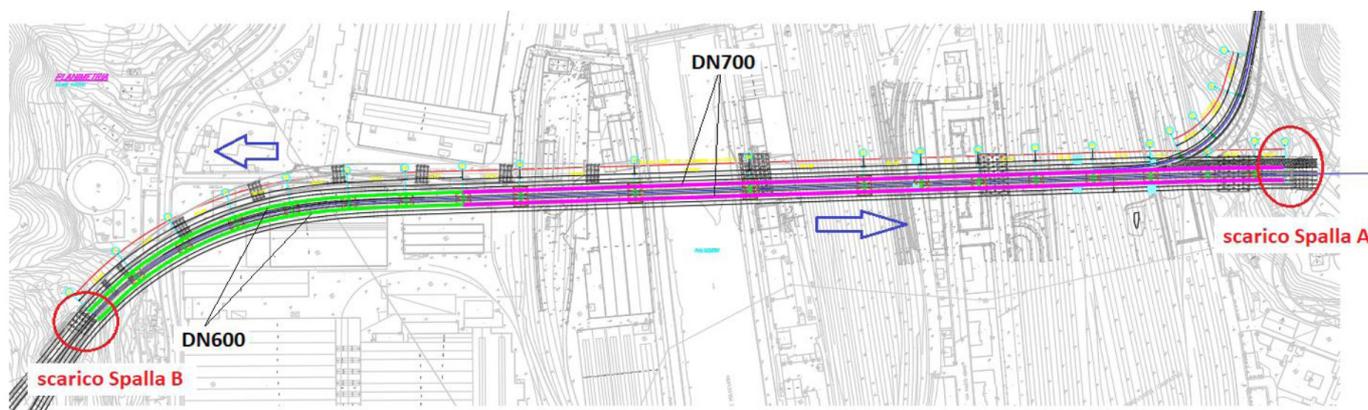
Planimetria schematica dei collettori di drenaggio (Fonte: NG1200E11RHID0002C01 "Relazione idraulica – drenaggio di piattaforma")
